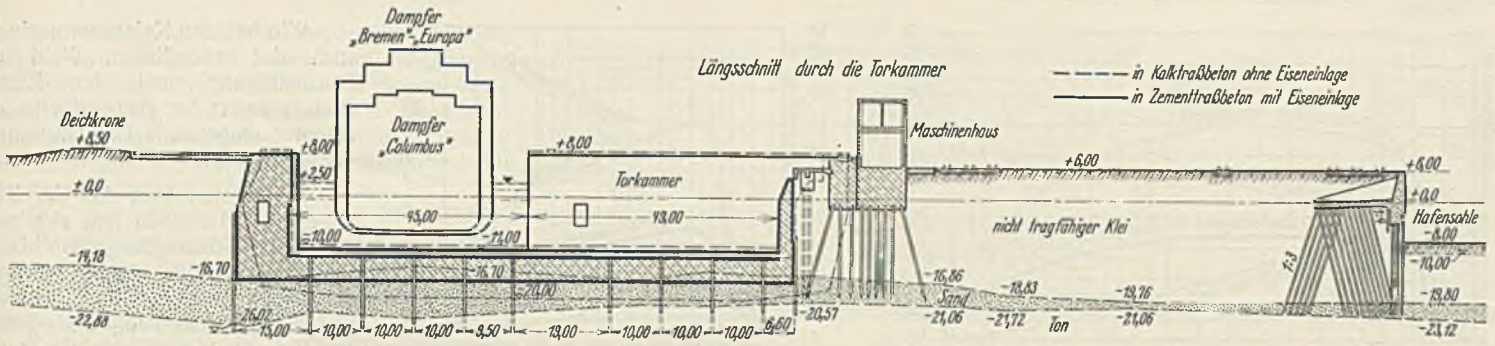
Vergleich des Außenhauptes in Kalktraßbeton ohne Eiseneinlagen (Unterwasserschüttverfahren) und in Zementtraßbeton mit Eiseneinlagen (Trockenbauverfahren).
